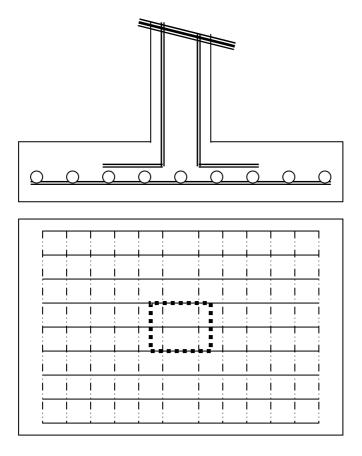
Detalles del refuerzo en zapata aislada del ejemplo 12.3
